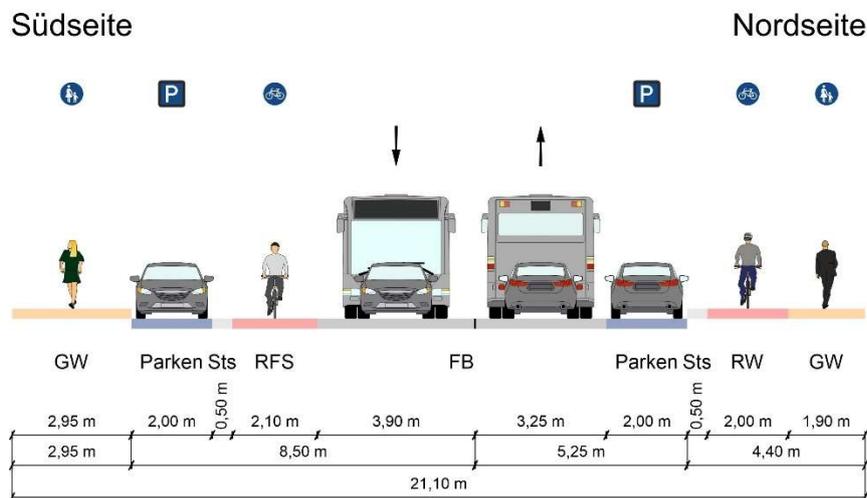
Querschnitt G-G Prüfeninger Straße Bestand nach Abschluss Sanierung (Quelle: INOVAPLAN GmbH)
